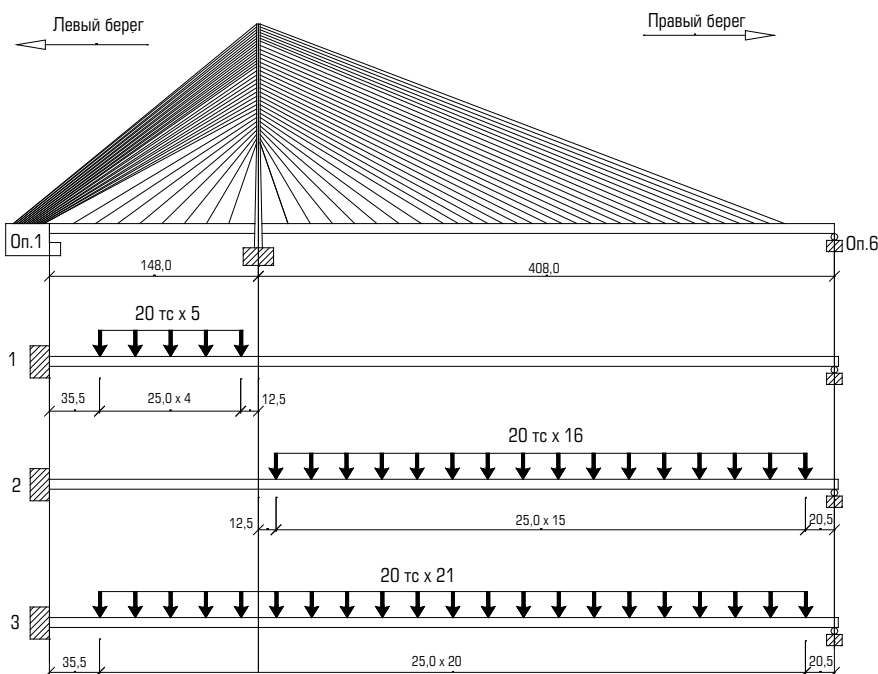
Схема расположения испытательной нагрузки на вантовом пролетном строении в продольном направлении
